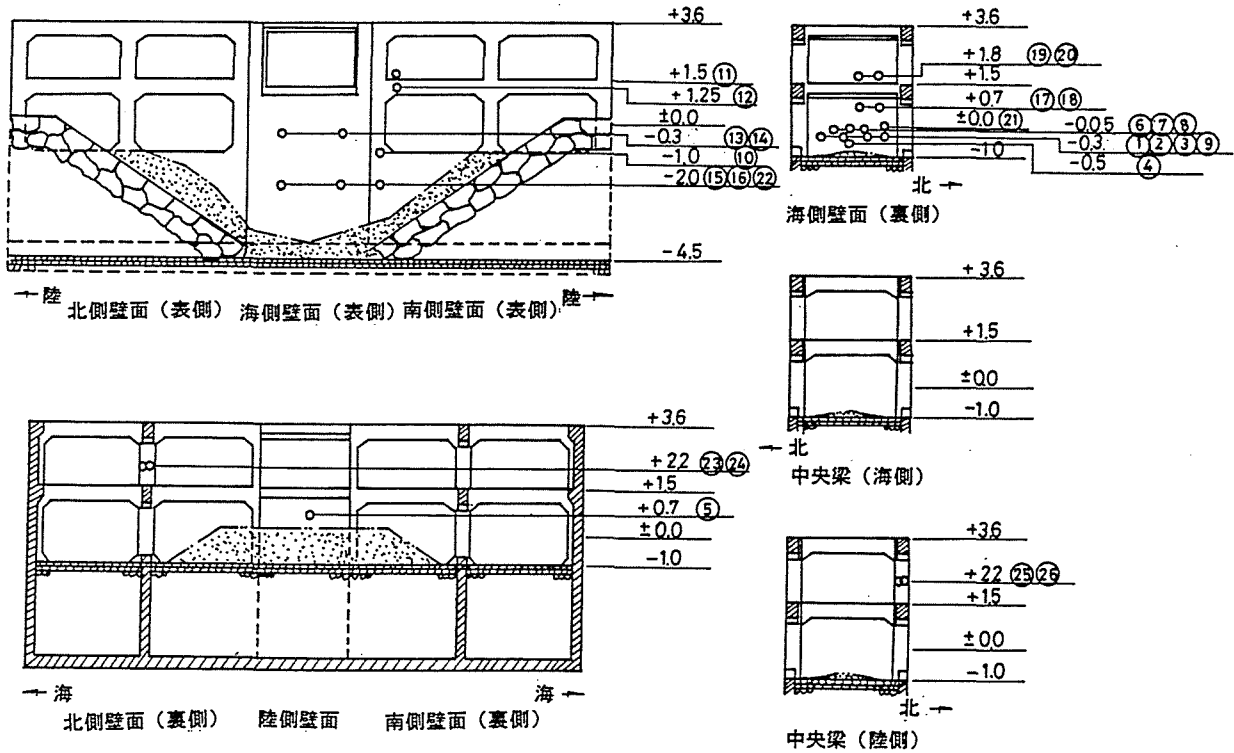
コンクリートコアの採取位置 (○数字箇所)
